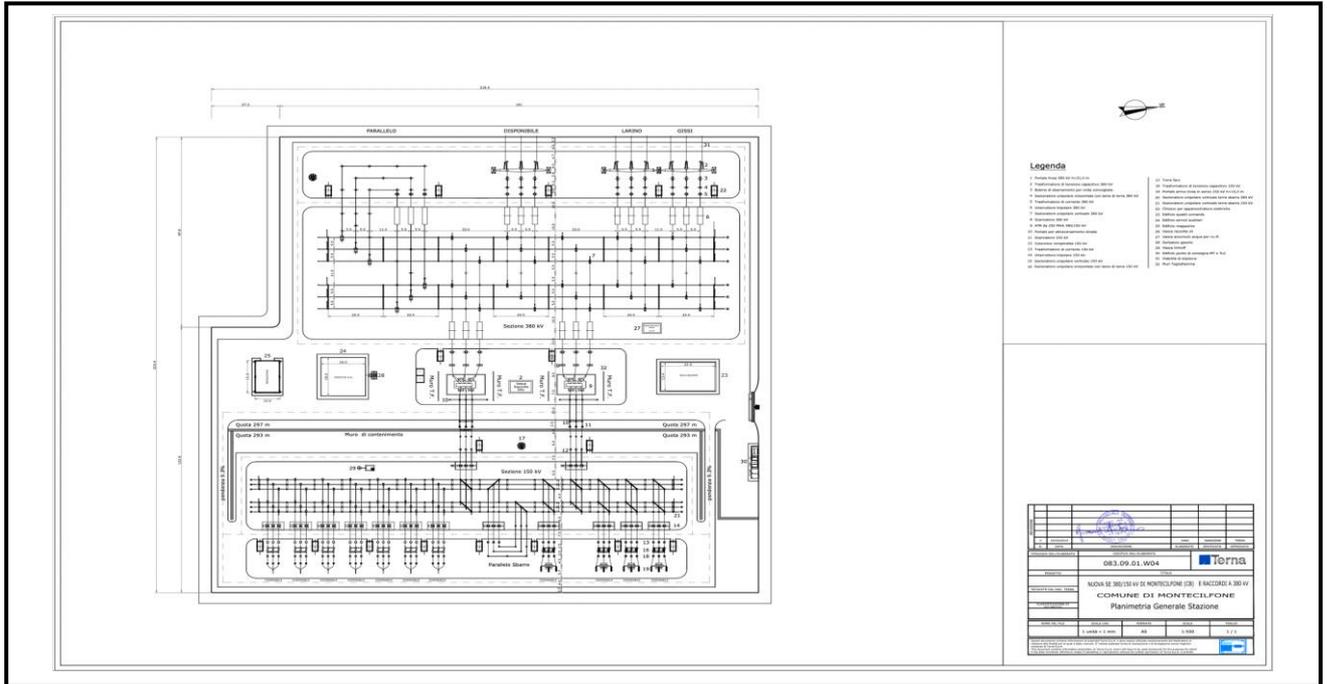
planimetria elettromeccanica Stazione 380/150 kV
